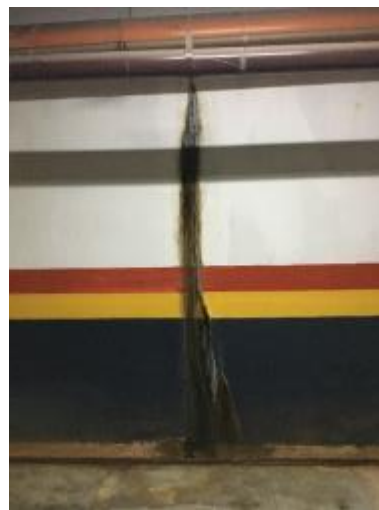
Trincas ou fissuras formadas por infiltração.
